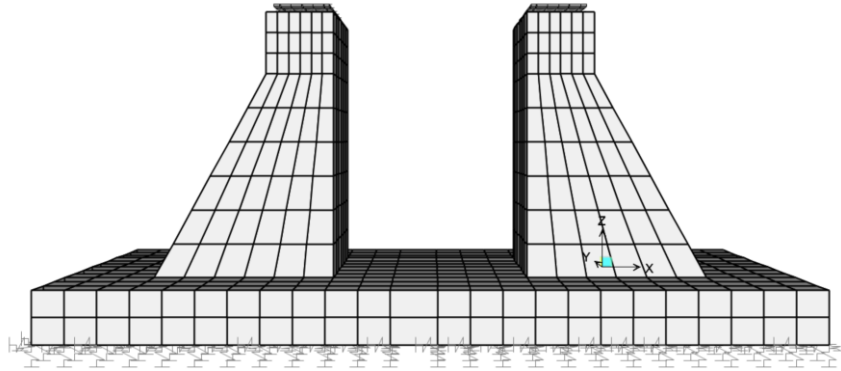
Sistema con aisladores - Vista: Elevación.
